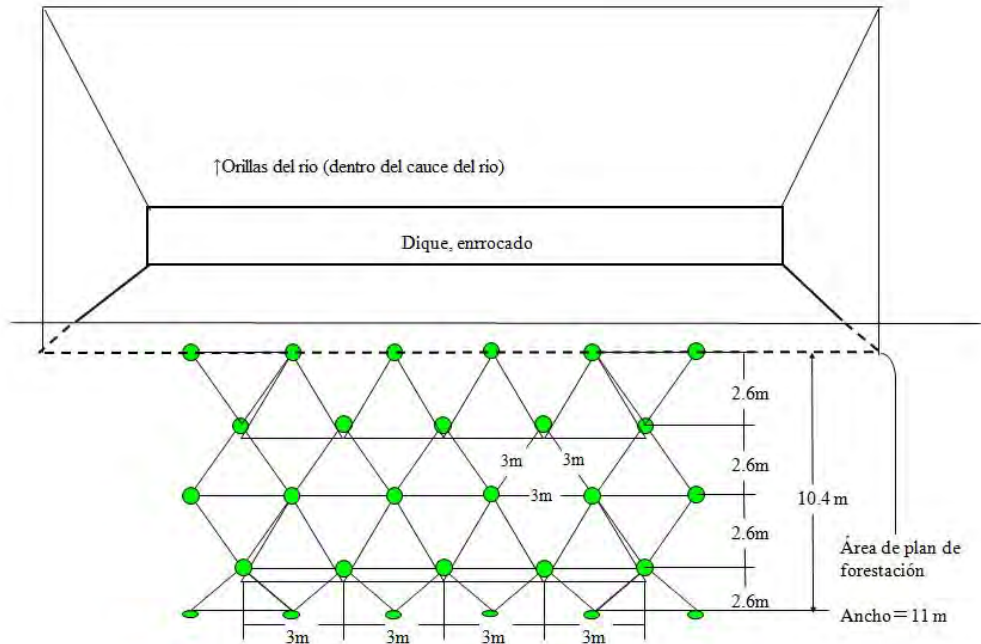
Ubicación del diseño del plan de forestación en la estructura ribereña
